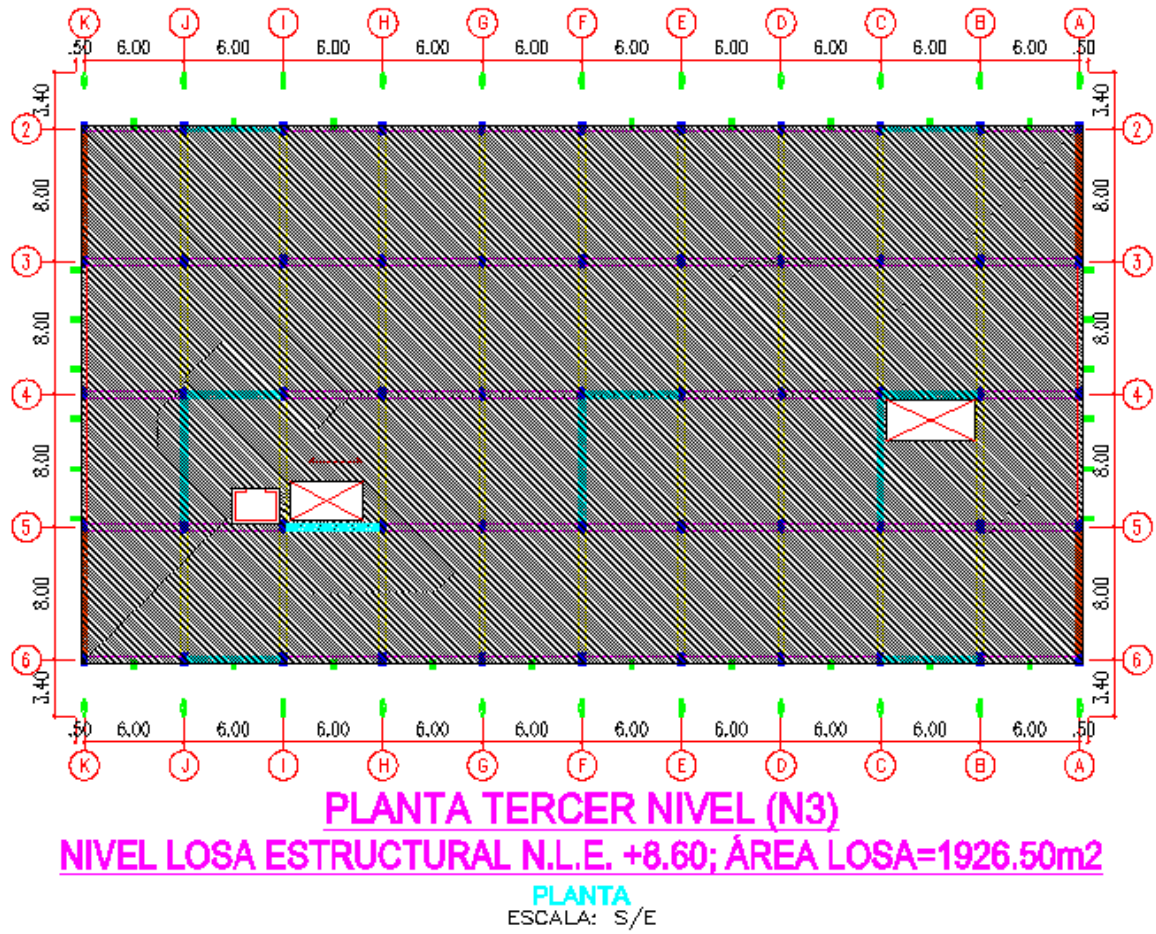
Planta tercer nivel – N.L.E. +8.60m – área de losa (diafragma)=1926.50m²
